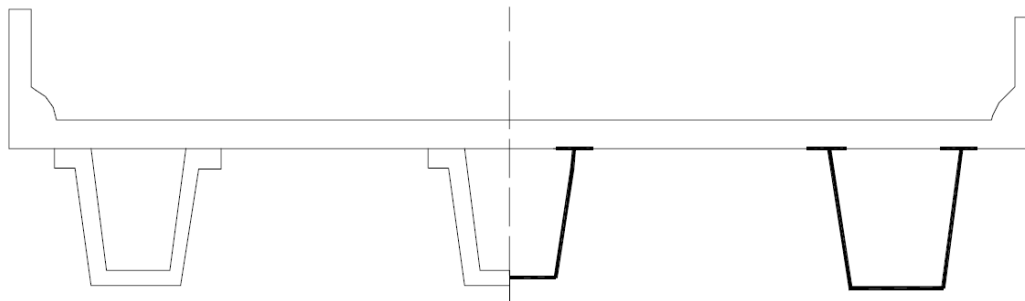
Sección transversal de puente con vigas cajón abiertas de acero o concreto reforzado prefabricado (AASHTO, 2007)
